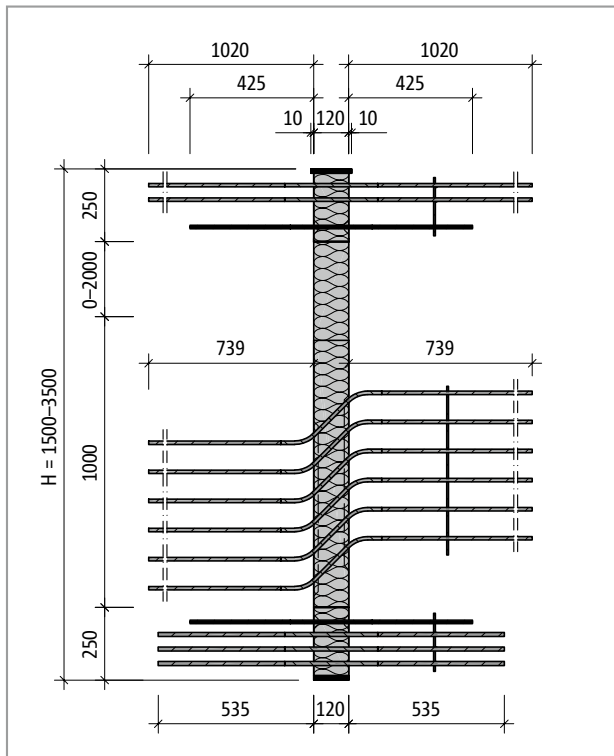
Schöck Isokorb® XT type W-M4: Product section
